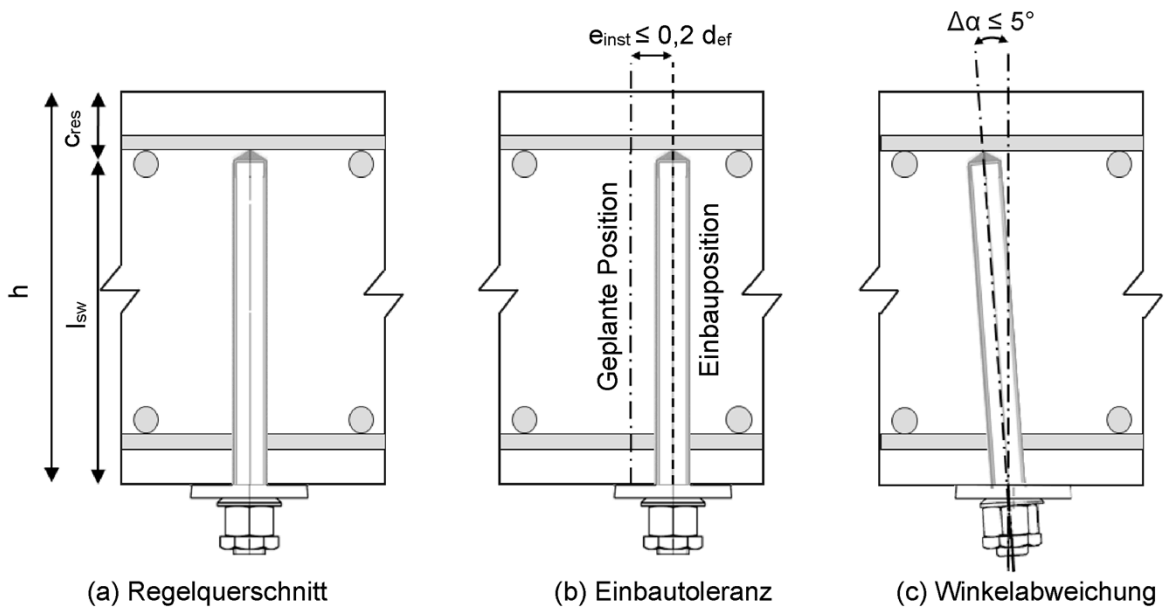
Einbaubedingungen mit Abmessungen und zulässigen Einbautoleranzen, wobei:
